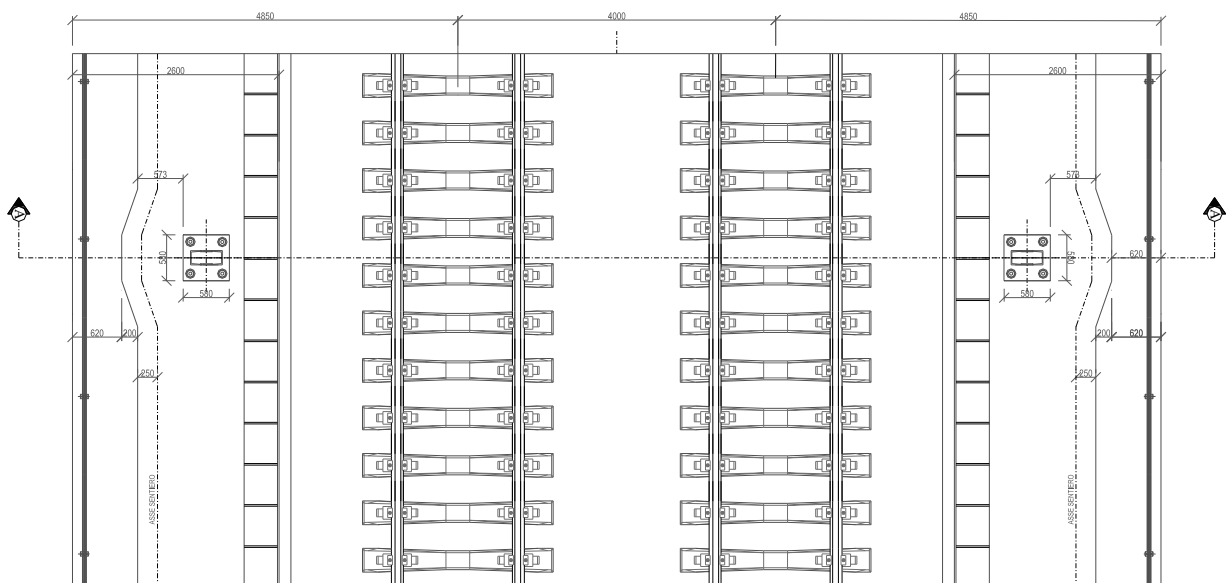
Stralcio planimetrico sezione tipo ferroviaria in viadotto a doppio binario
